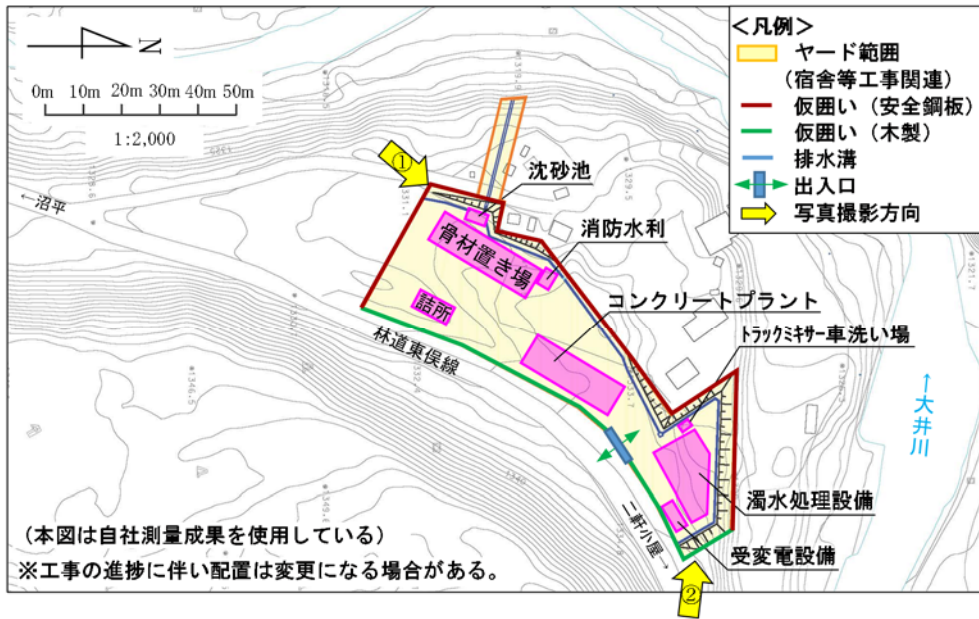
施工計画図、現況写真 (工事施工ヤードA)
